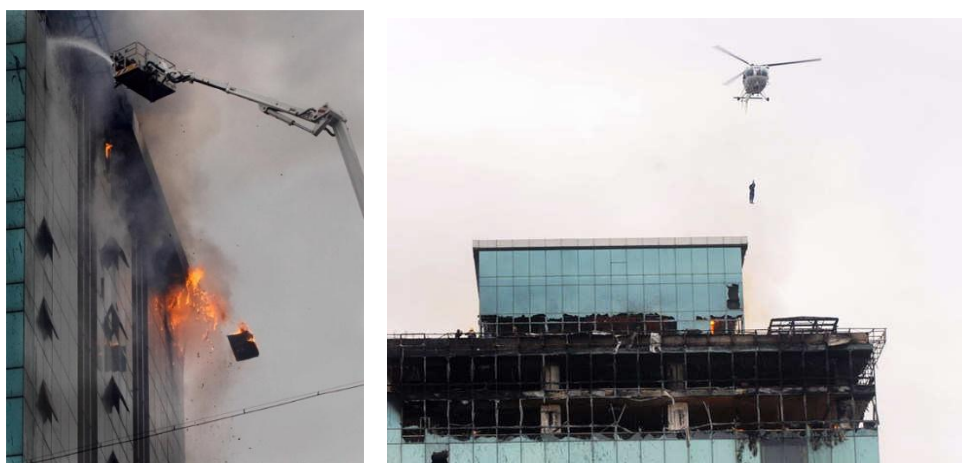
Фото руйнування фасадної системи будівлі під час пожежі.
